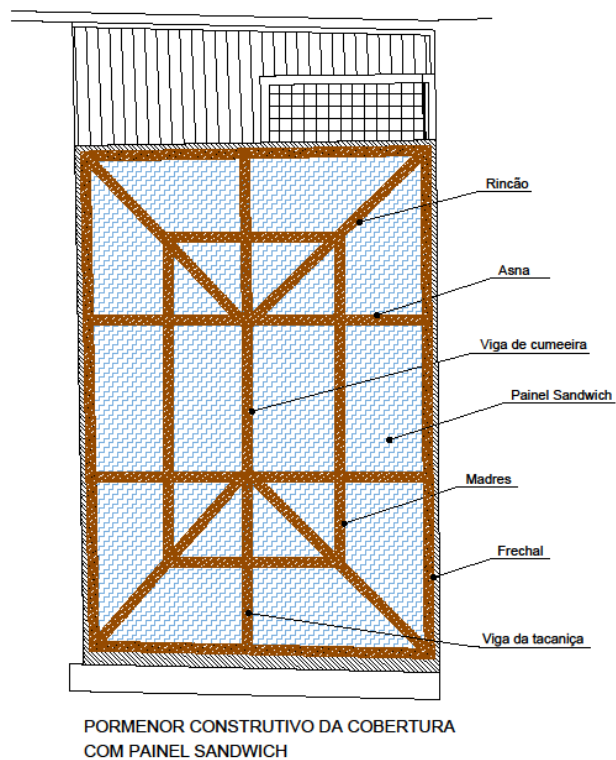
Planta estrutural da cobertura com painel sandwich (depois)
